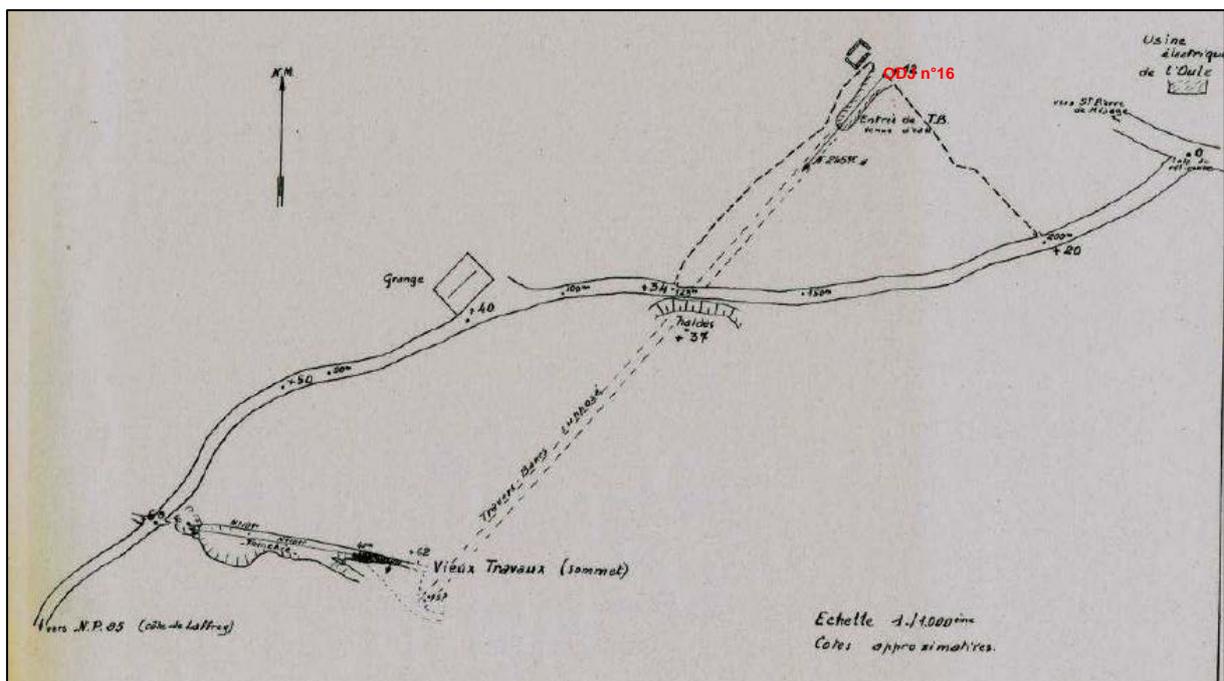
Plan des travaux miniers sur la concession de Mésage
